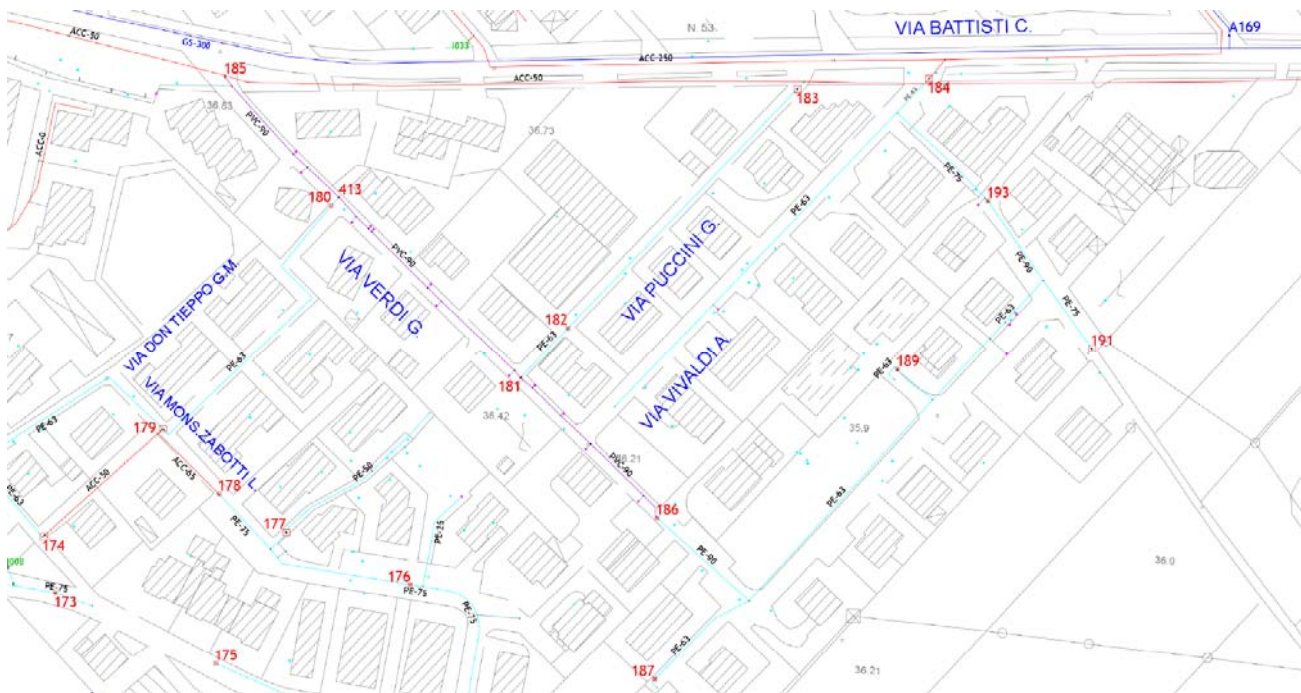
Planimetria della rete acquedotto – Via Vivaldi e via Verdi
